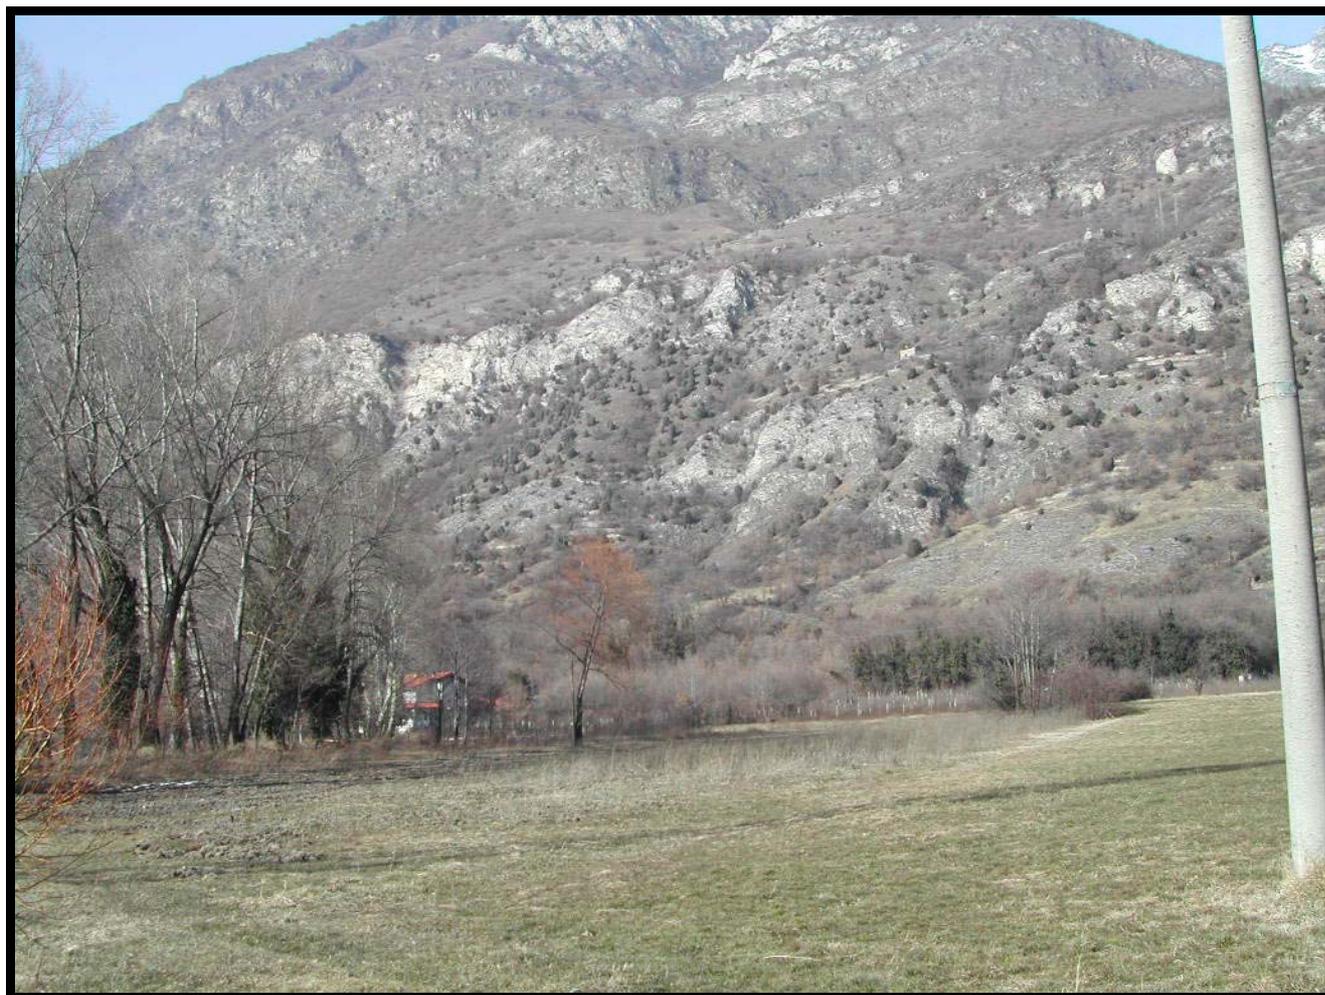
Area interessata dall'imbocco della galleria di ventilazione di Foresto.
